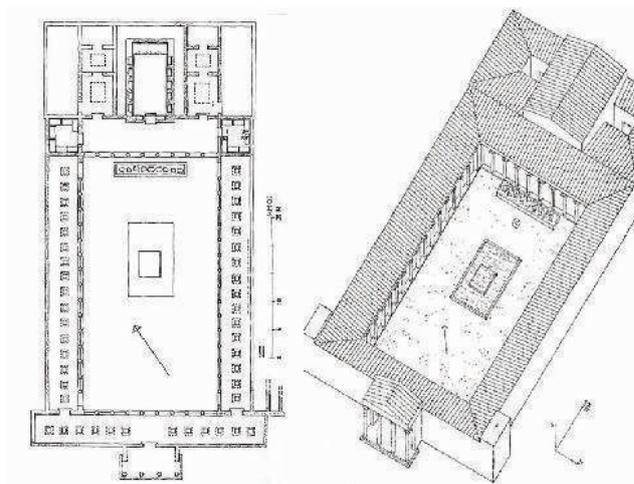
Reconstrucción planta y axonometría de la Academia de Platón. Atenas.
